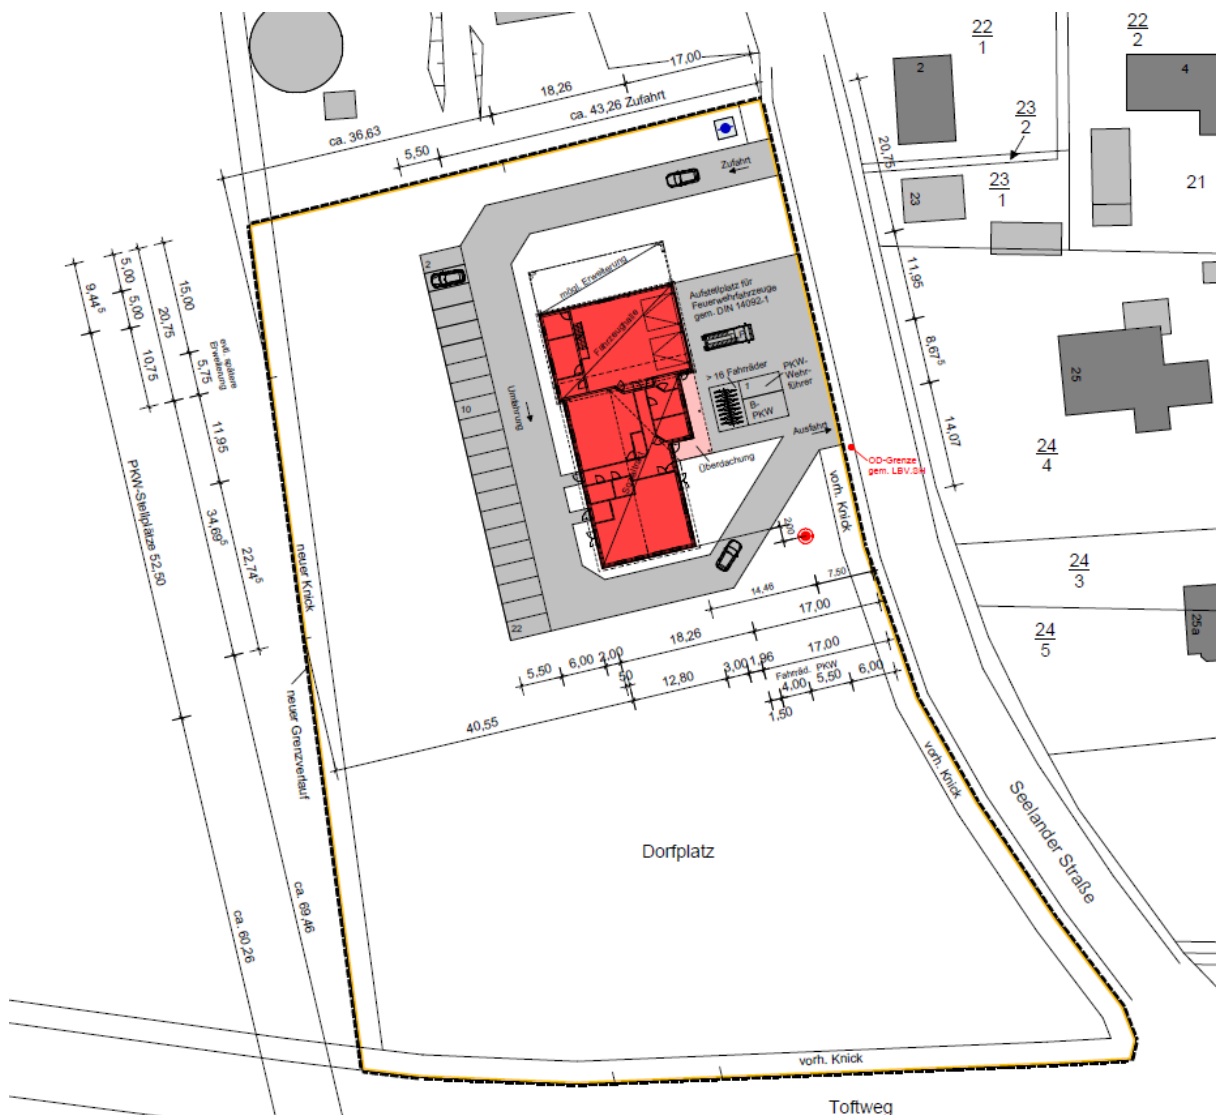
Lageplan Neubau Feuerwehrgerätehaus Lindewitt. OT Sillerup. Quelle: Architekturbüro Hansen & Hansen. Stand: 04.09.2024.
